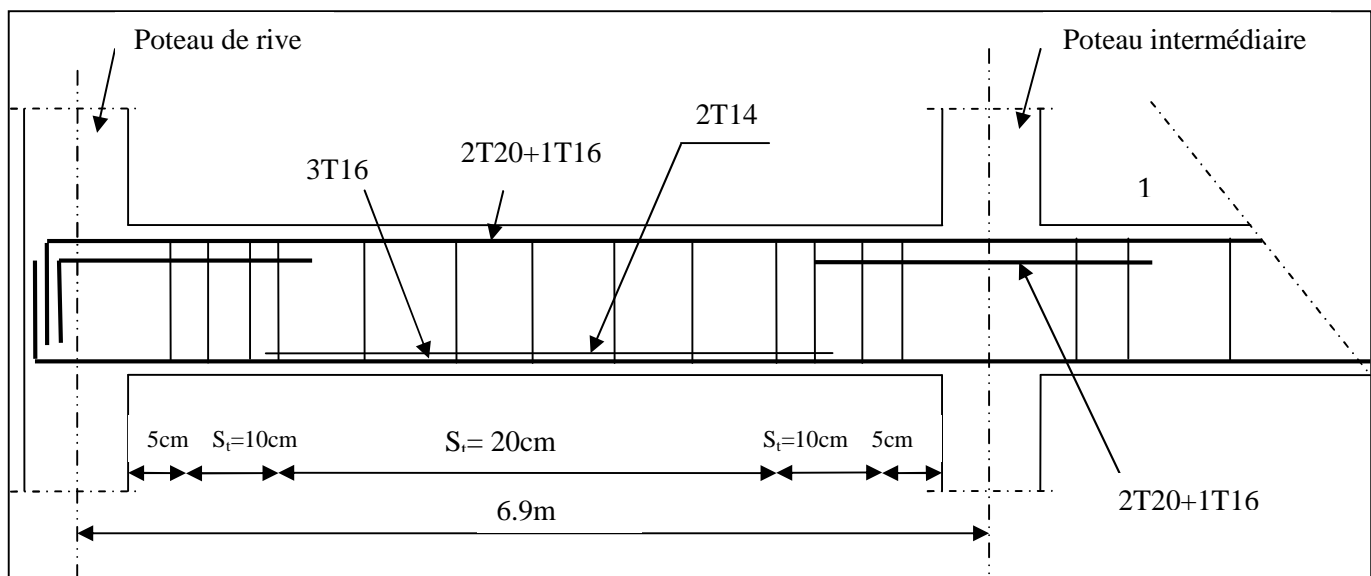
Schéma de ferrailage des poutres principales + de 5 m.
